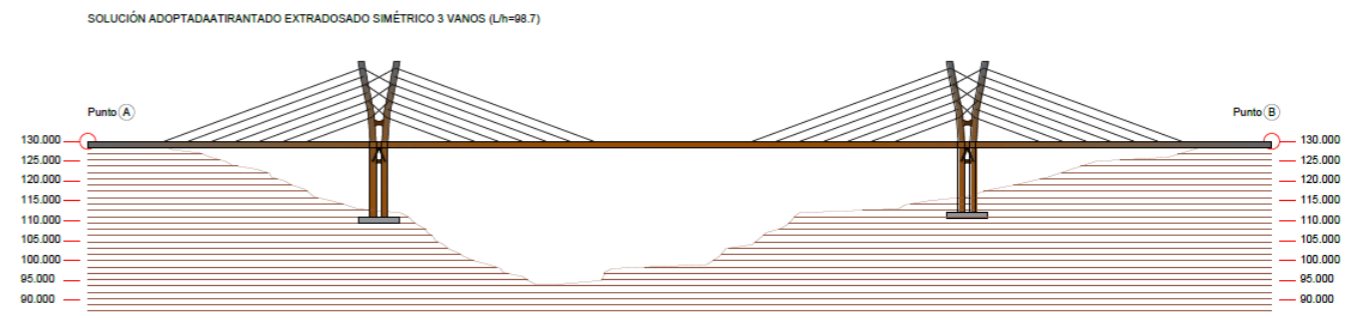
Alzado de pasarela atirantada (solución adoptada). Fuente: Elaboración Propia (AutoCAD)
